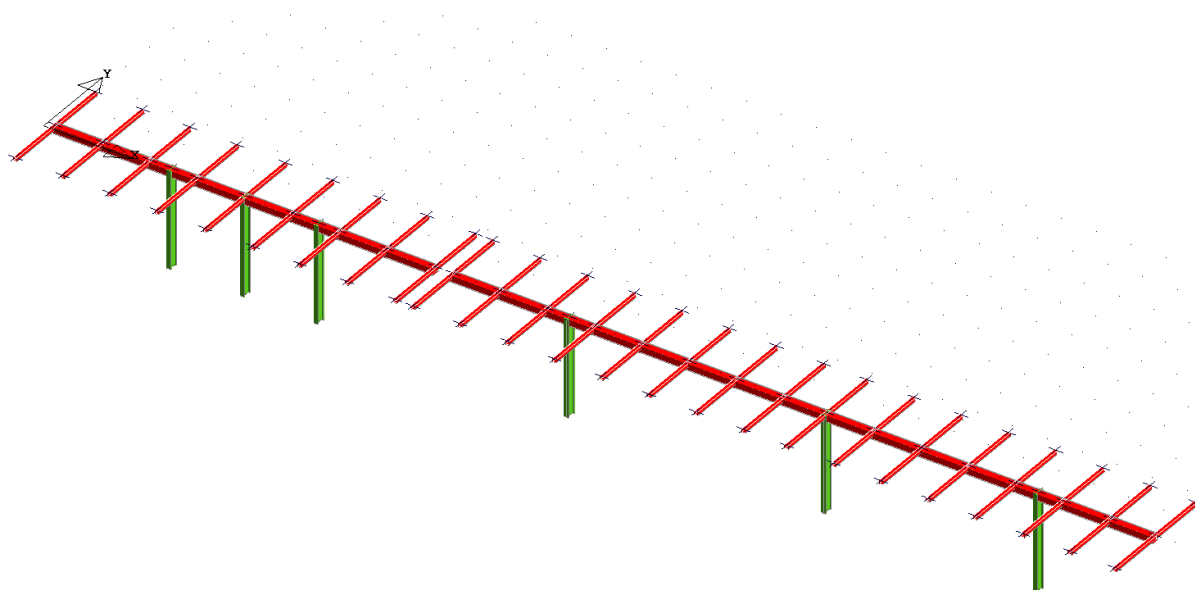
Vista assonometrica modello strutturale con posizione della “vela” orizzontale
